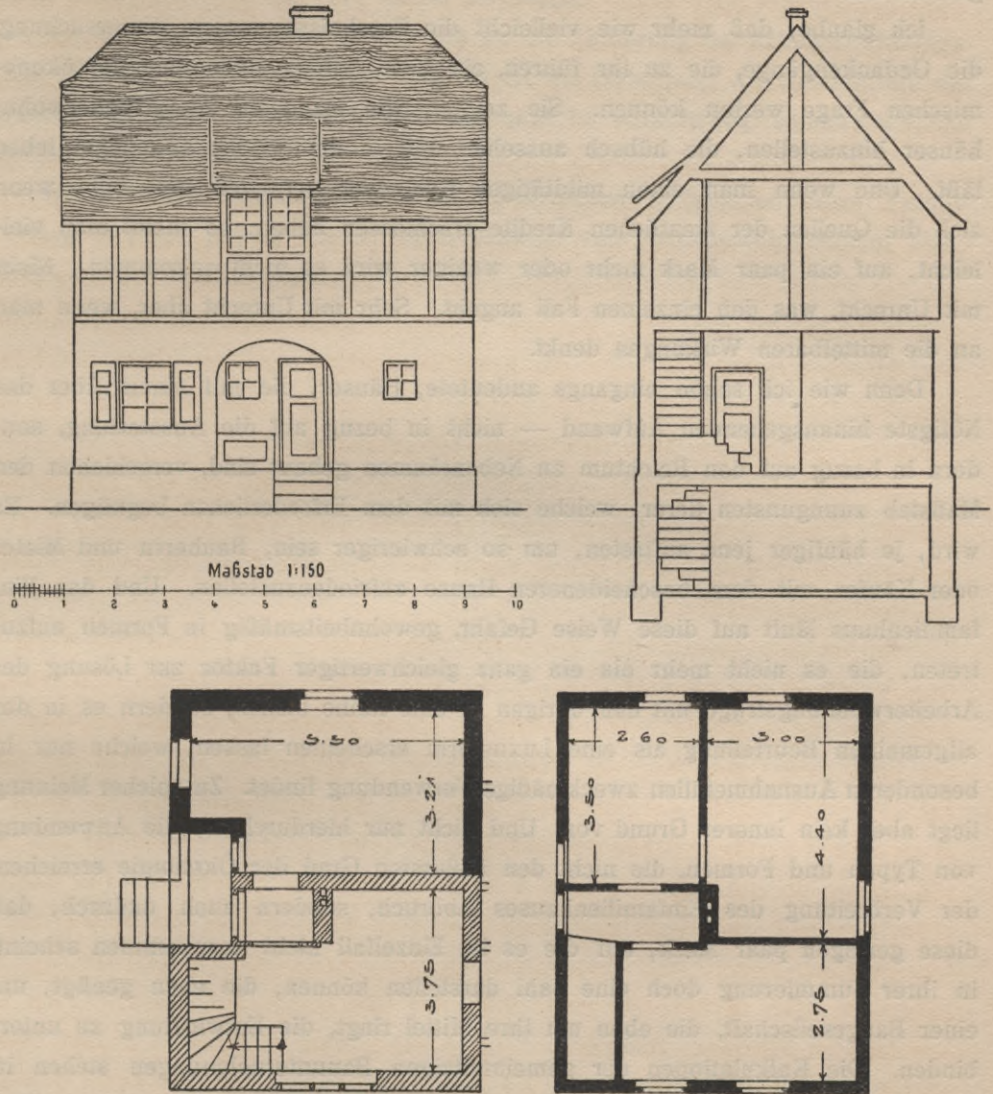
Typ 4b: Fünf Wohnräume, von denen zwei unten, drei oben liegen. Variante 4. Zweiteilung des Erdgeschoßgrundrisses (Einzelhaus). Beispiel nach dem Hause in Gronauerwald, Berg.-Gladbach Nr. 32. (Vgl. Gronauerwald a. a. O.)
